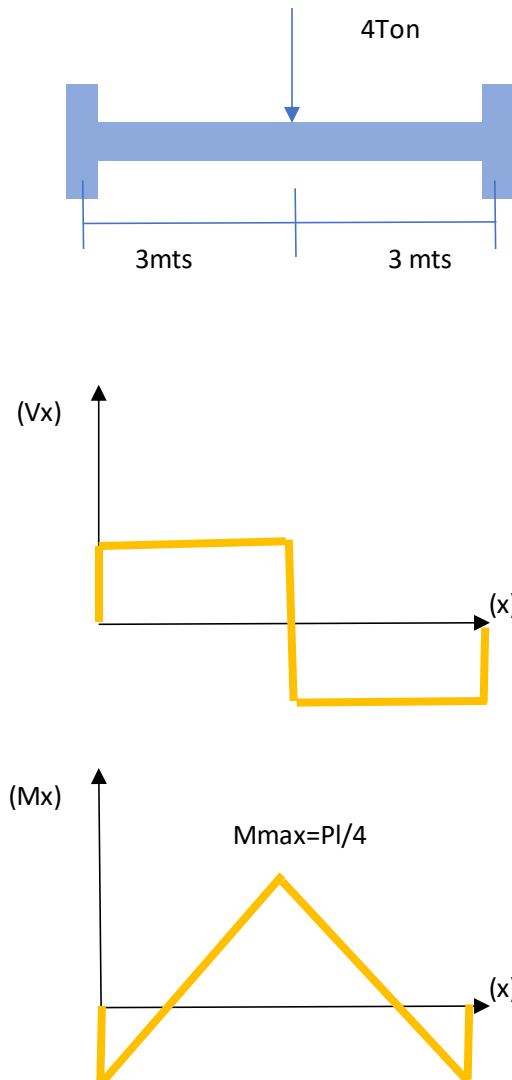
Caso 5, Viga de entrepiso doblemente empotrada. Fuente: propia
